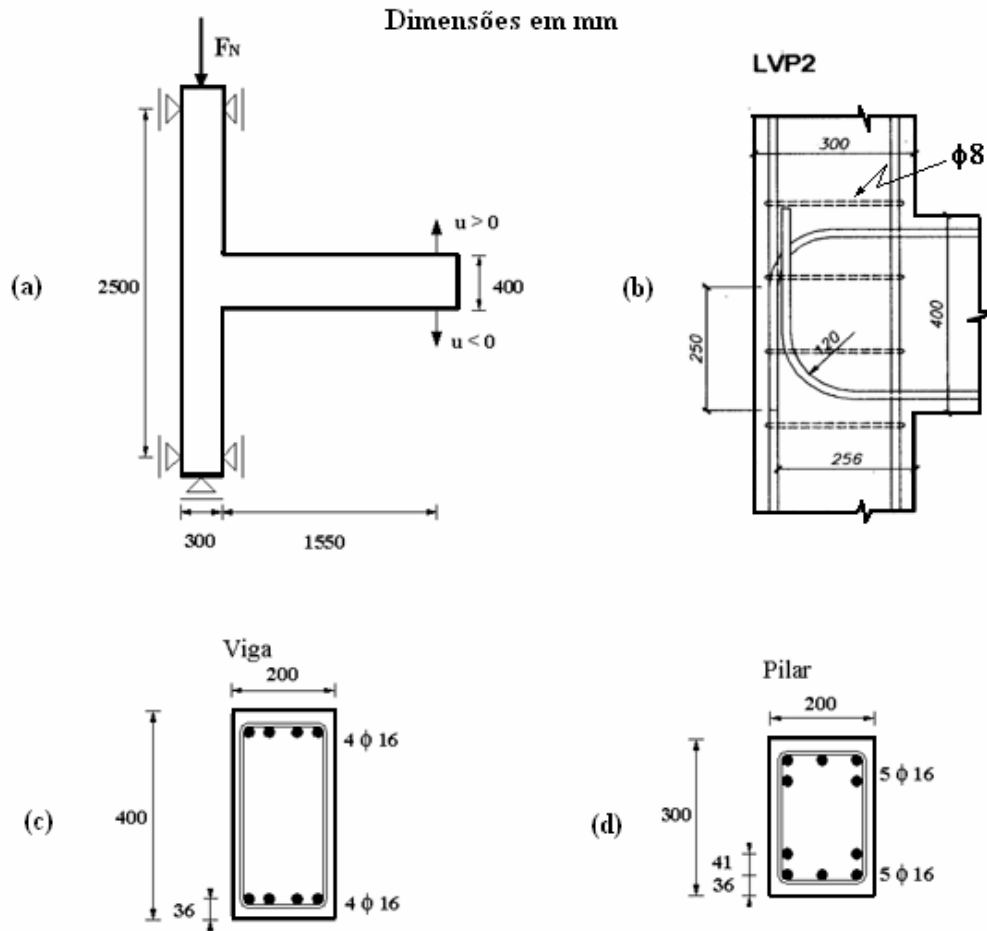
Pórtico de Alva: (a) geometria e carregamento, (b) detalhe dos estribos em LVP2, (c) seção da viga, (d) seção do pilar
